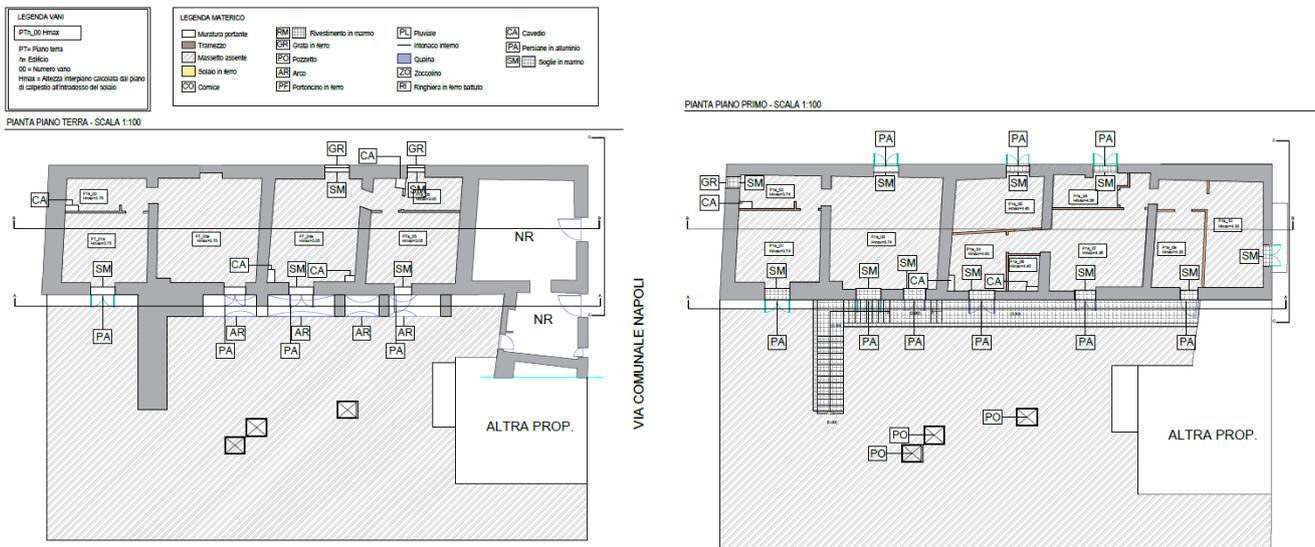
Rilievo materico edificio A (pianta piano terra a sinistra, pianta primo piano a destra)
